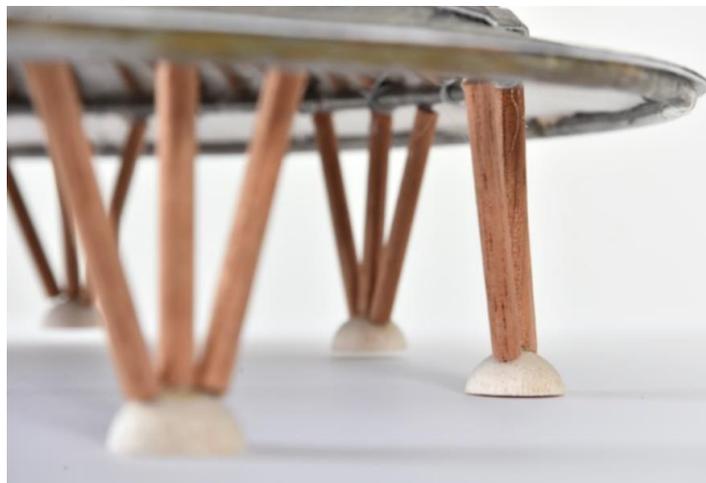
Foto maqueta Escala 1.75, Domo Kiddies, detalle de cimentación y solera.
